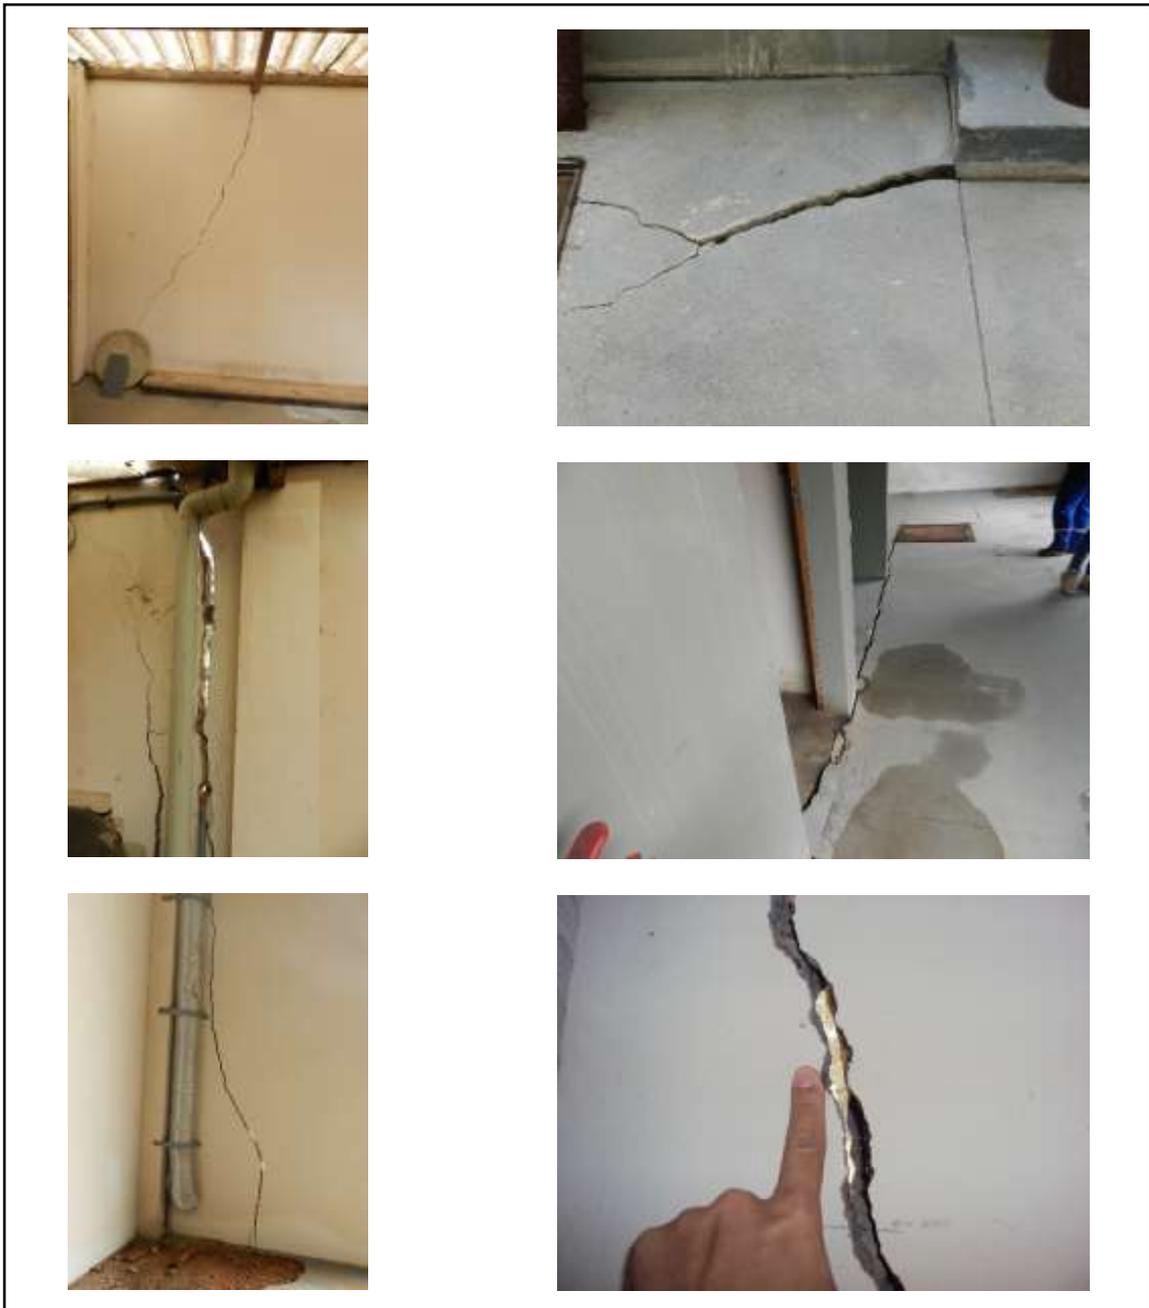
Rachaduras no piso e paredes do prédio da ETE Vila de Pedra Azul configurando risco estrutural.
